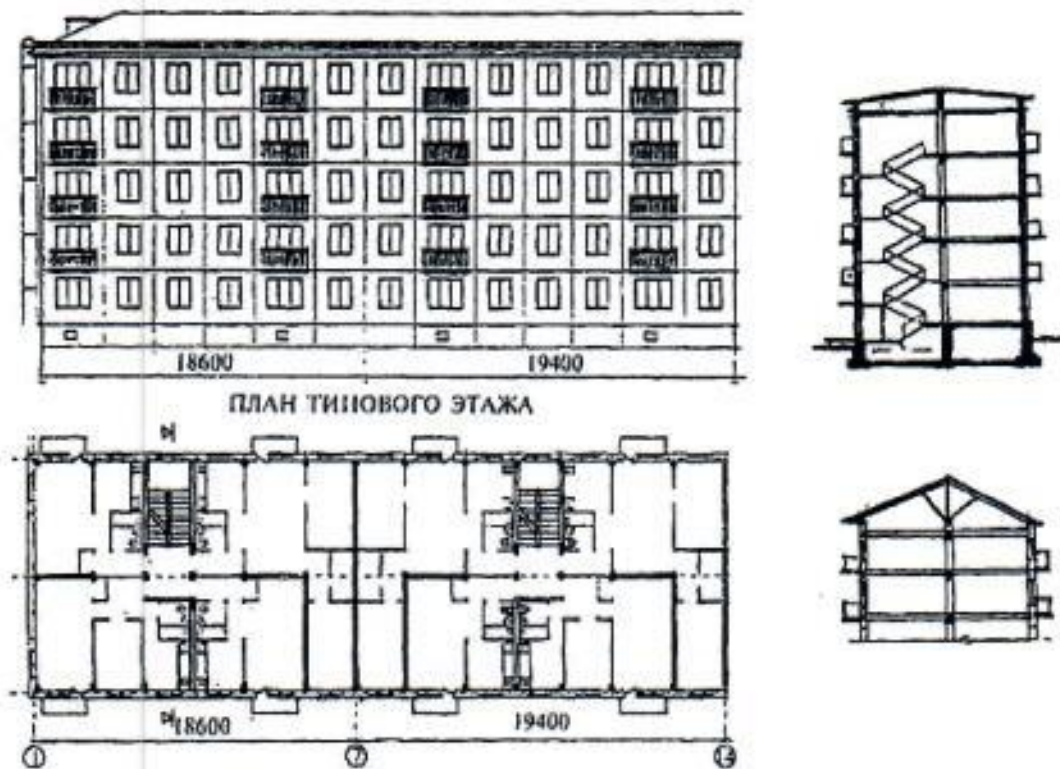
Фасад, план типового этажа и разрез крупнопанельного жилого дома серии 1-335 с неполным каркасом
